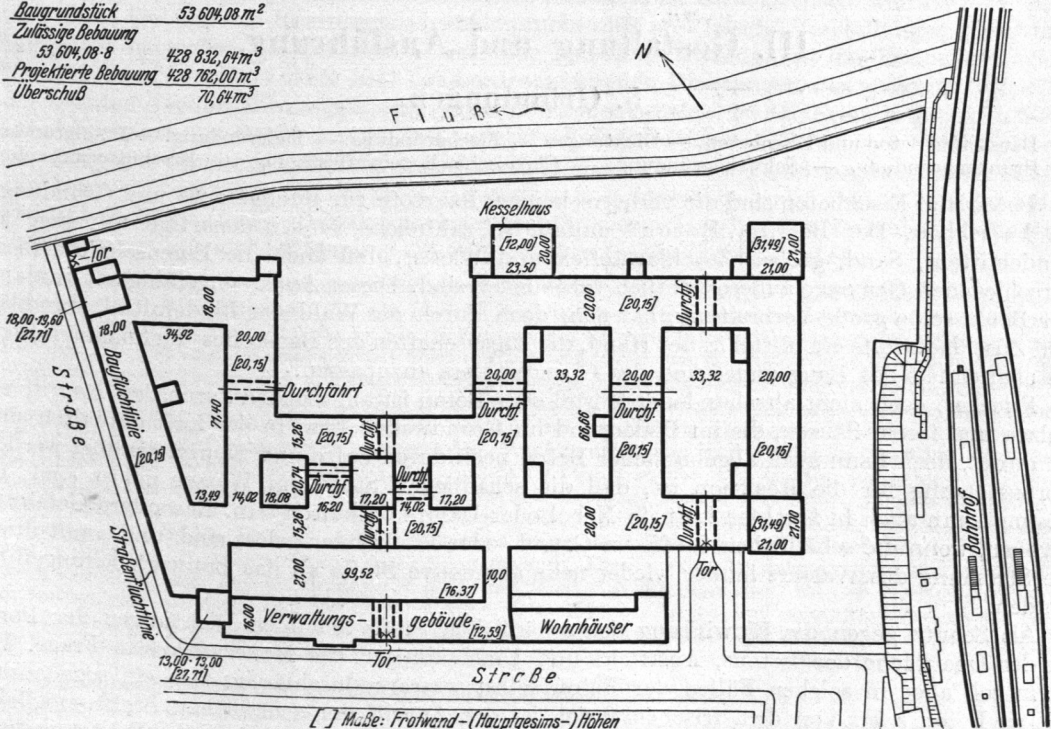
Bebauungsplan eines Fabrikgrundstücks mit Angaben für die Baumassenberechnung.
